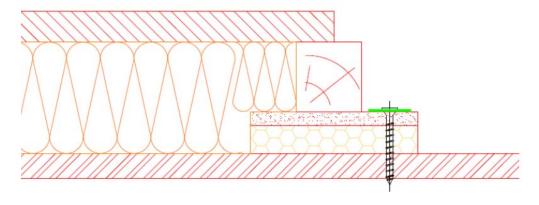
Pose du premier panneau sur l'élément porteur
